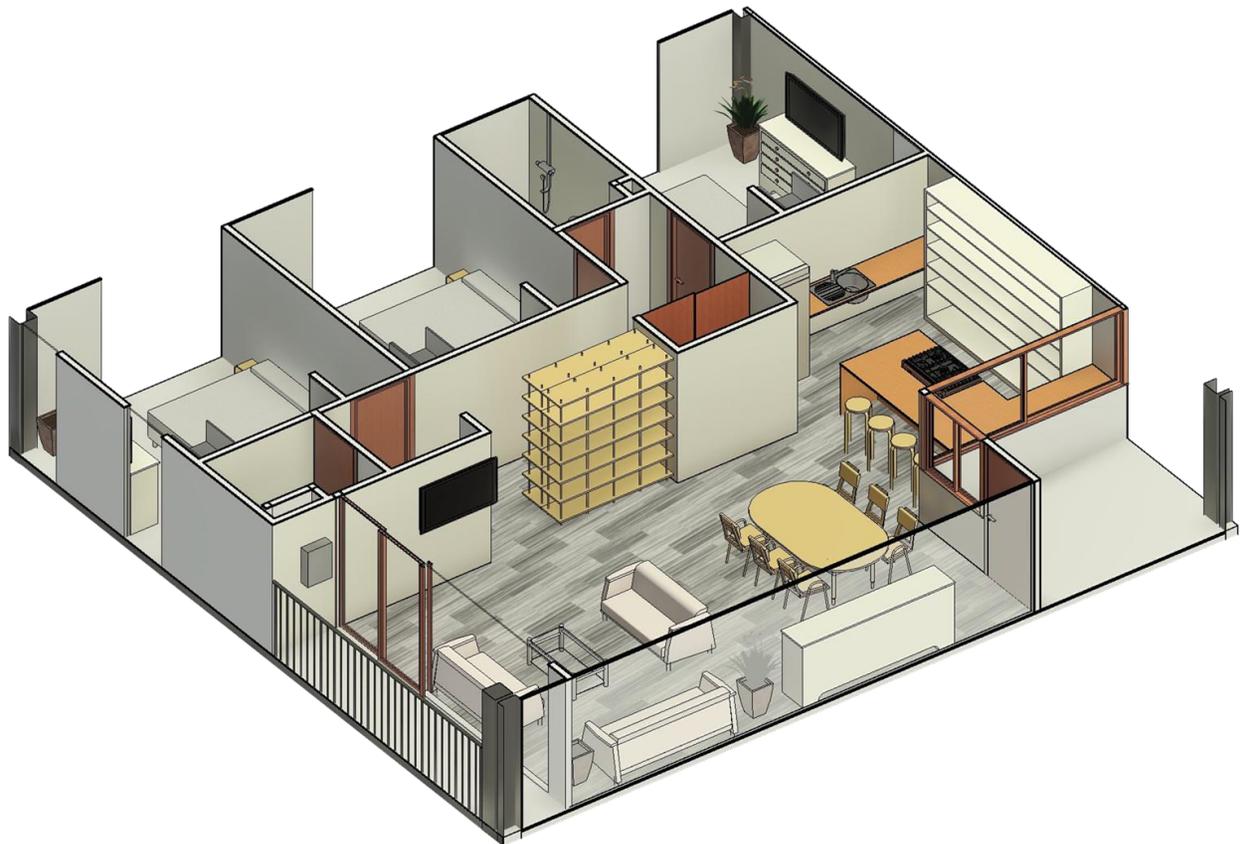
Propuesta final. Isométrico vivienda Sur oriente. Elaboración propia. 2022
